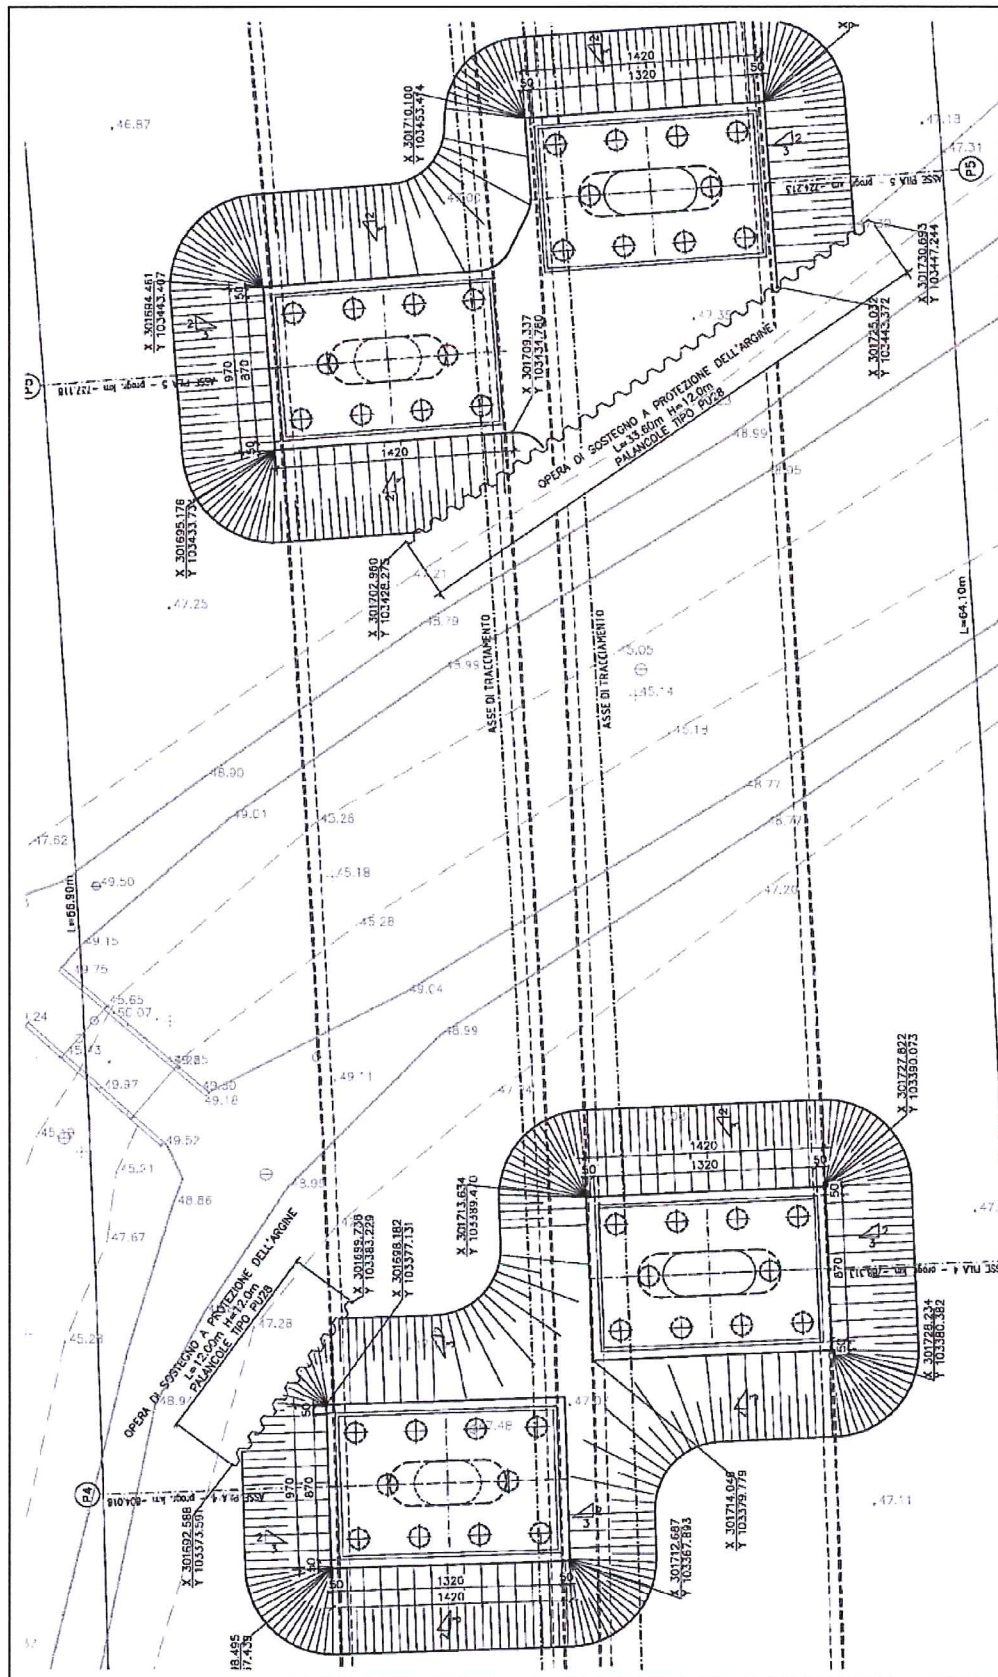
PIANTA DELLE OPERE DI SOSTEGNO
